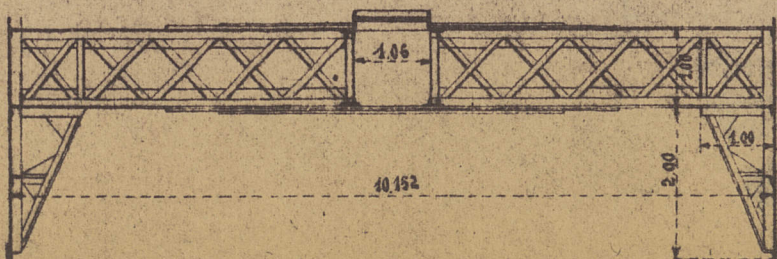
Coupe transversale du grand caisson de la cale sèche du Bâvre.
